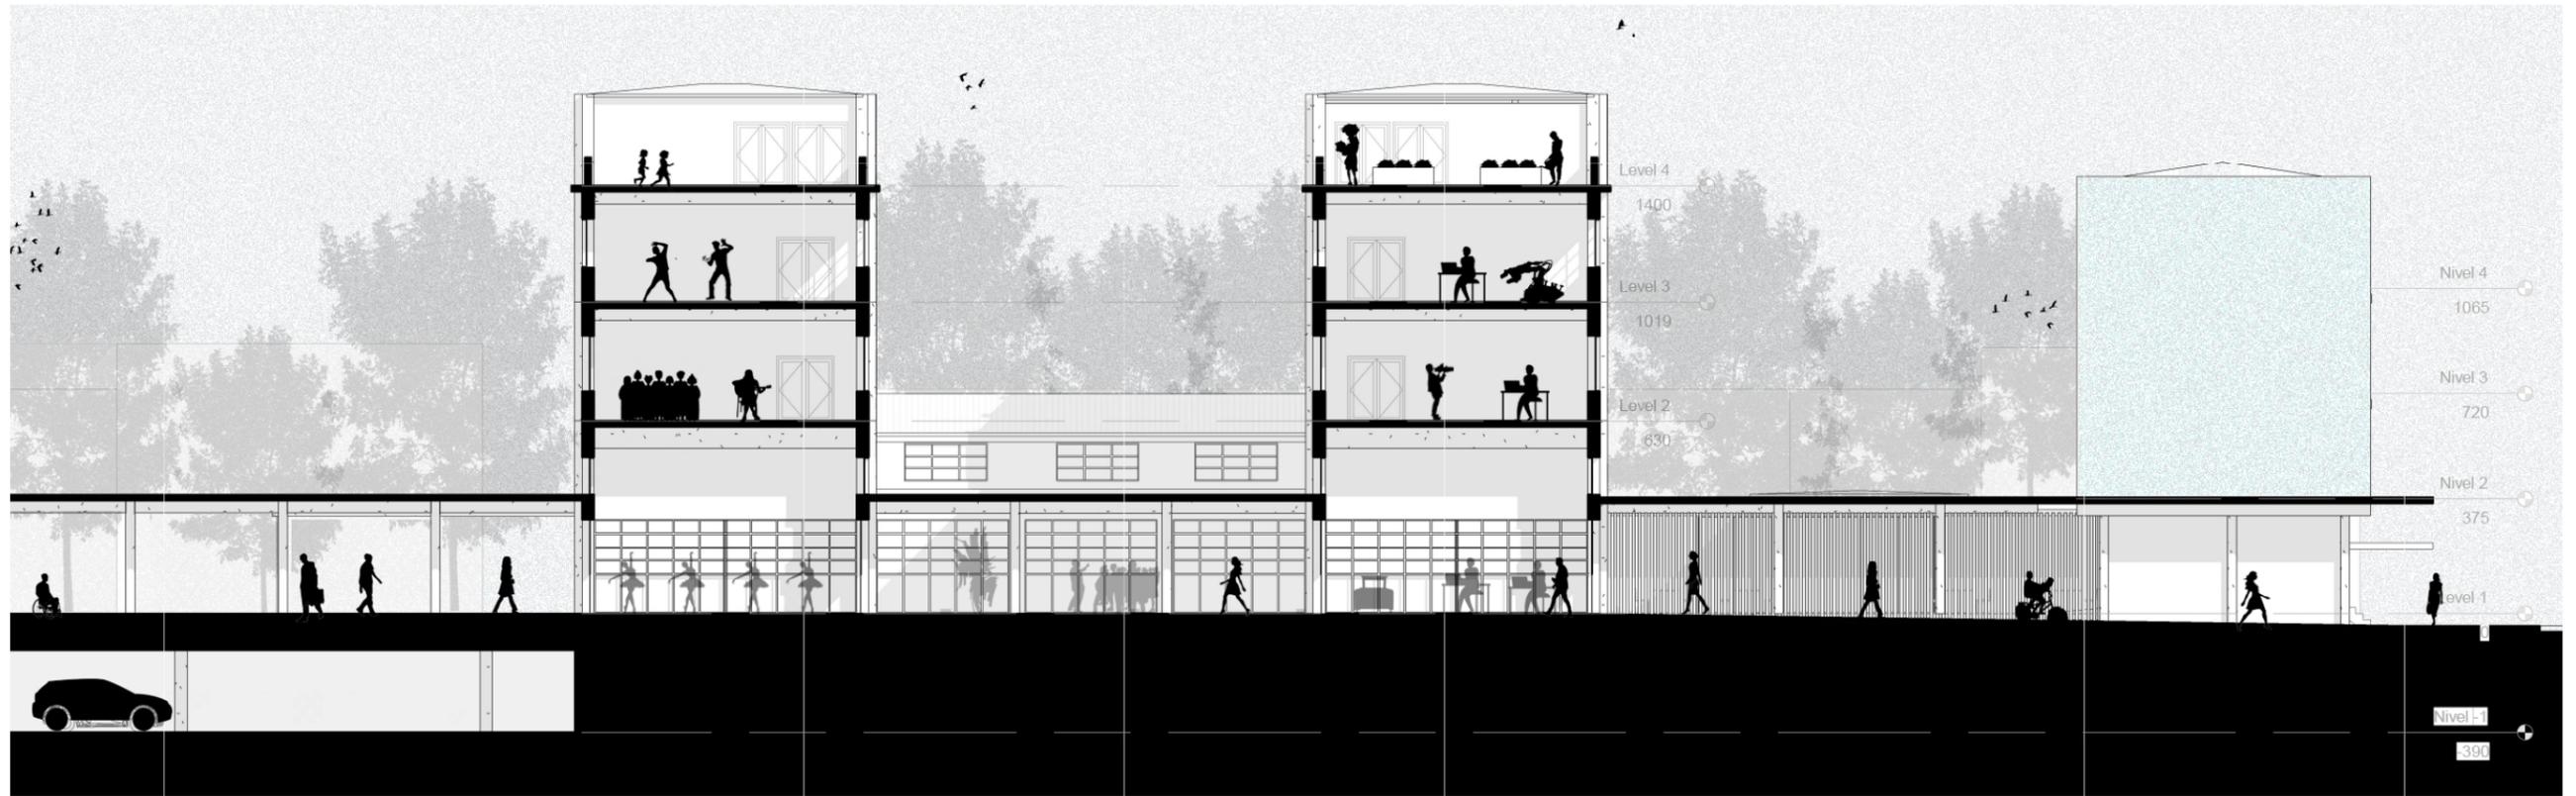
Corte longitudinal. Fuente: Elaboración propia.
